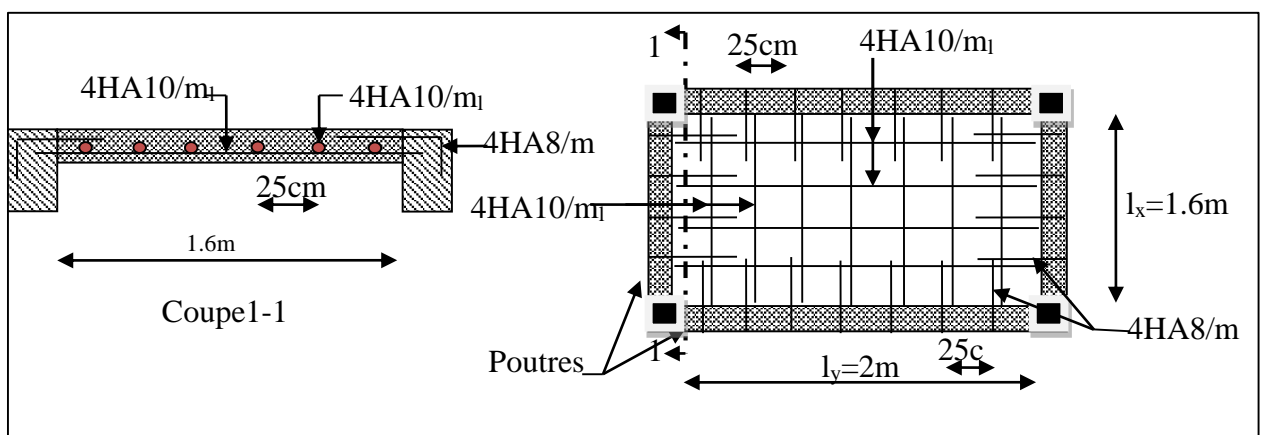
Schéma de ferrailage de la dalle sur 4 appuis.
